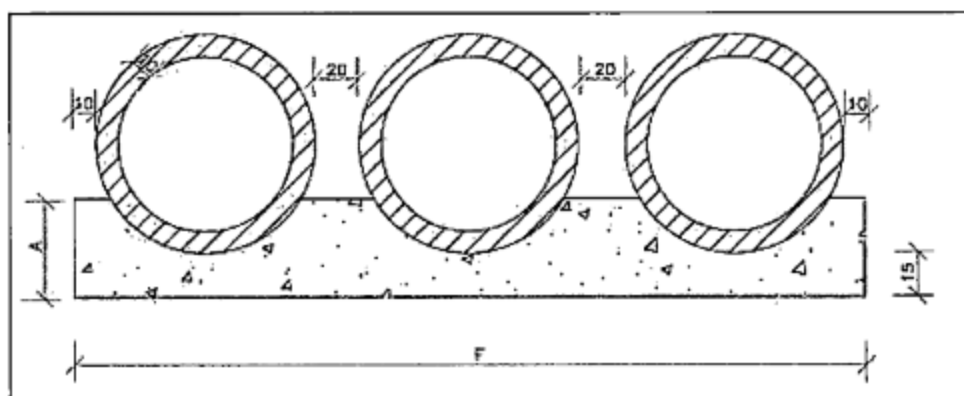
Bueiro triplo tubular de concreto, Manual de Dispositivos de Drenagem -Dnit
